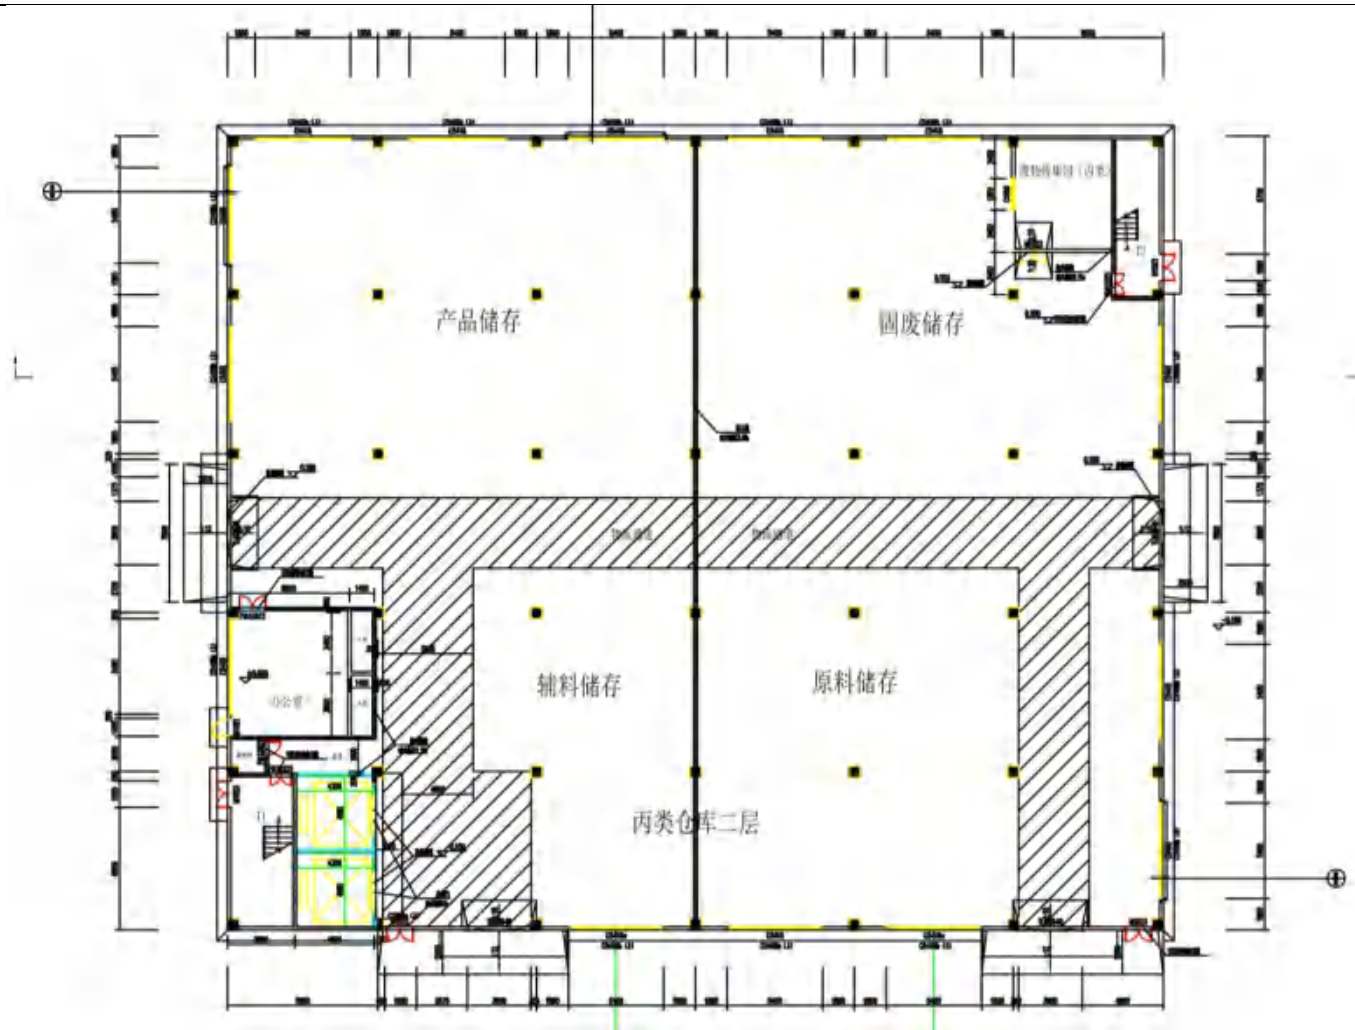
原技改扩建项目丙类仓库 2 层平面布置图
